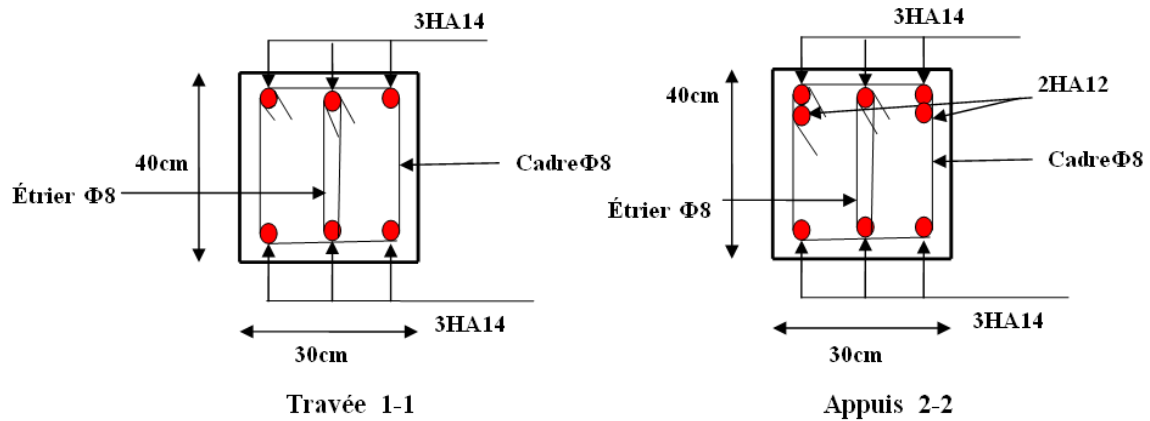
Schéma de ferrailage de la poutre principale de la terrasse
